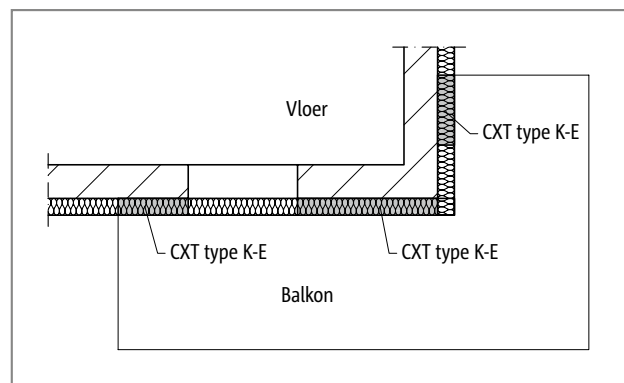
Schöck Isokorb® CXT type K-E: vrij uitkragend balkon
